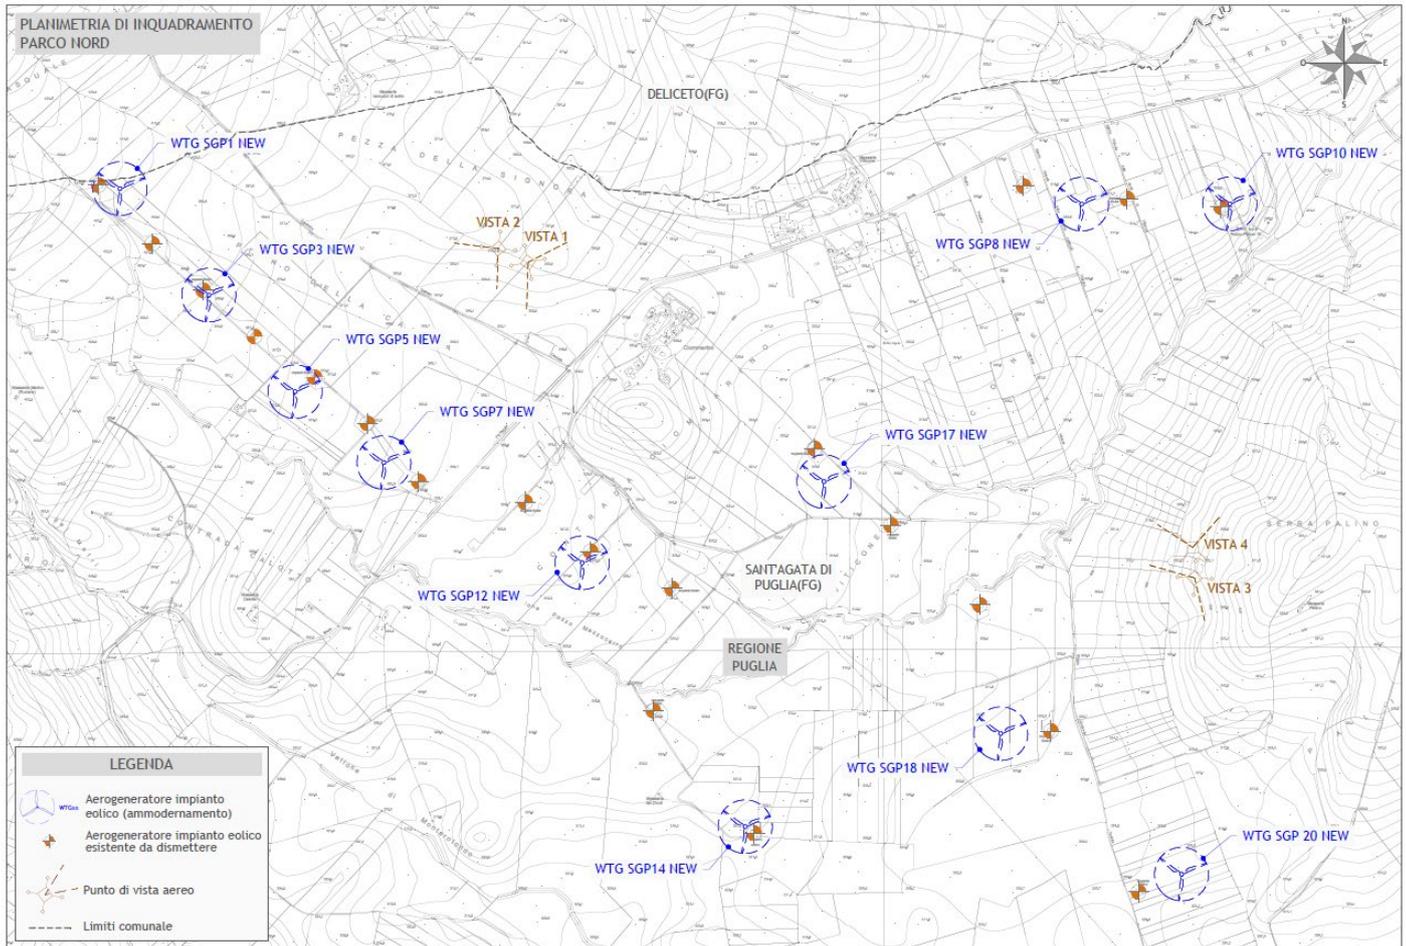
Stralcio della planimetria CTR con ubicazione punti di vista aerei per la documentazione fotografica attestante le condizioni del sito prima dell'intervento d'ammodernamento – Parco Nord
